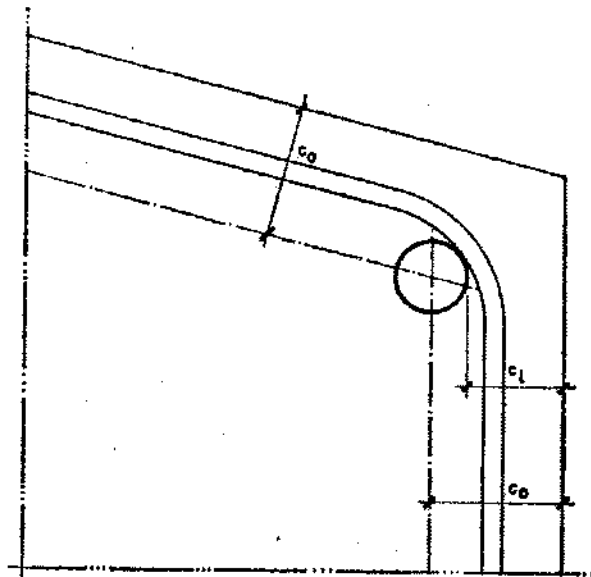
RECUBRIMIENTO c_1 DE LA ARMADURA LONGITUDINAL Y DISTANCIA c_0 DEL CENTRO DE LA ARMADURA AL PARAMENTO MAS PROXIMO.
